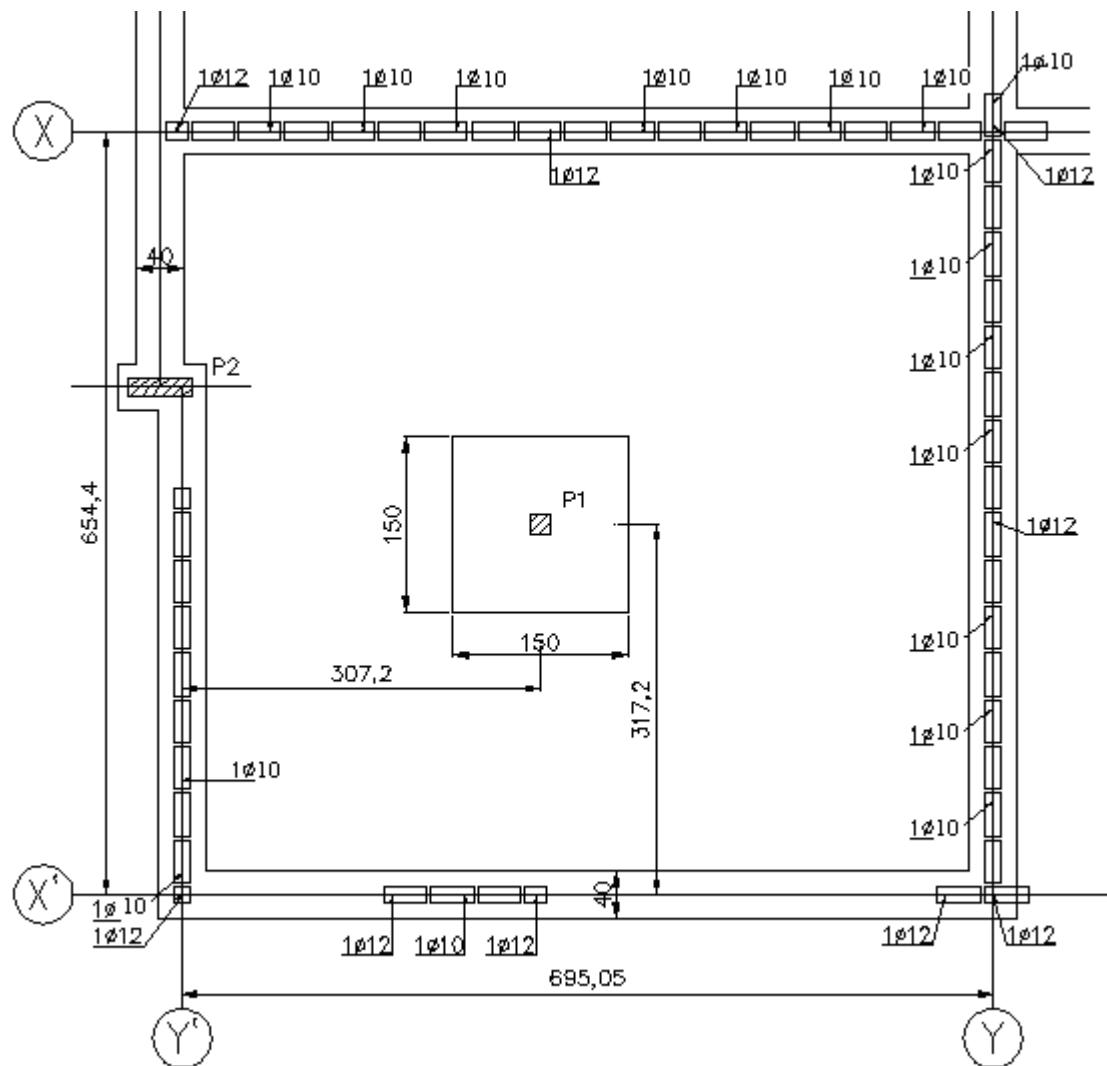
4. Distribución de la armadura vertical en planta. Edificio de 4 pisos del Tipo A
